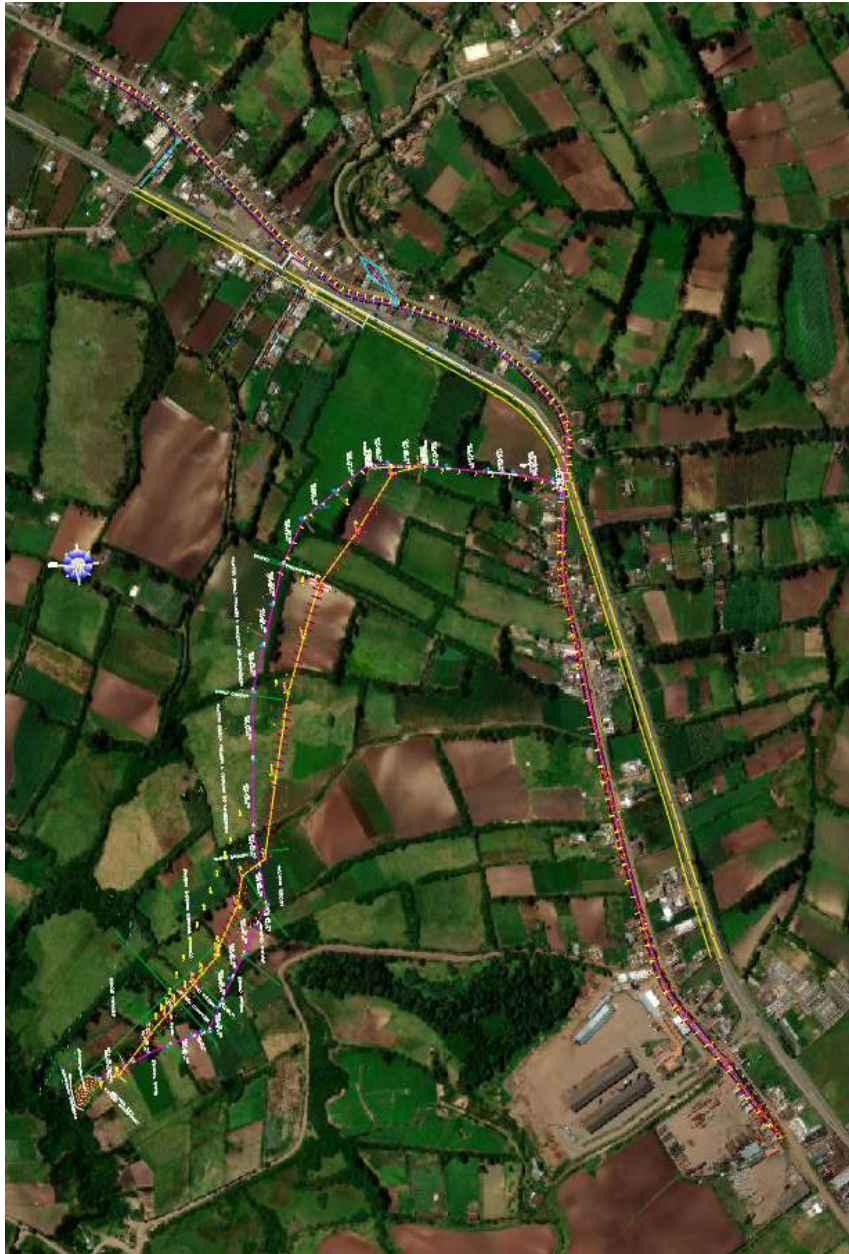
Trazado vista en planta nuevo alcantarillado vista satelital.
